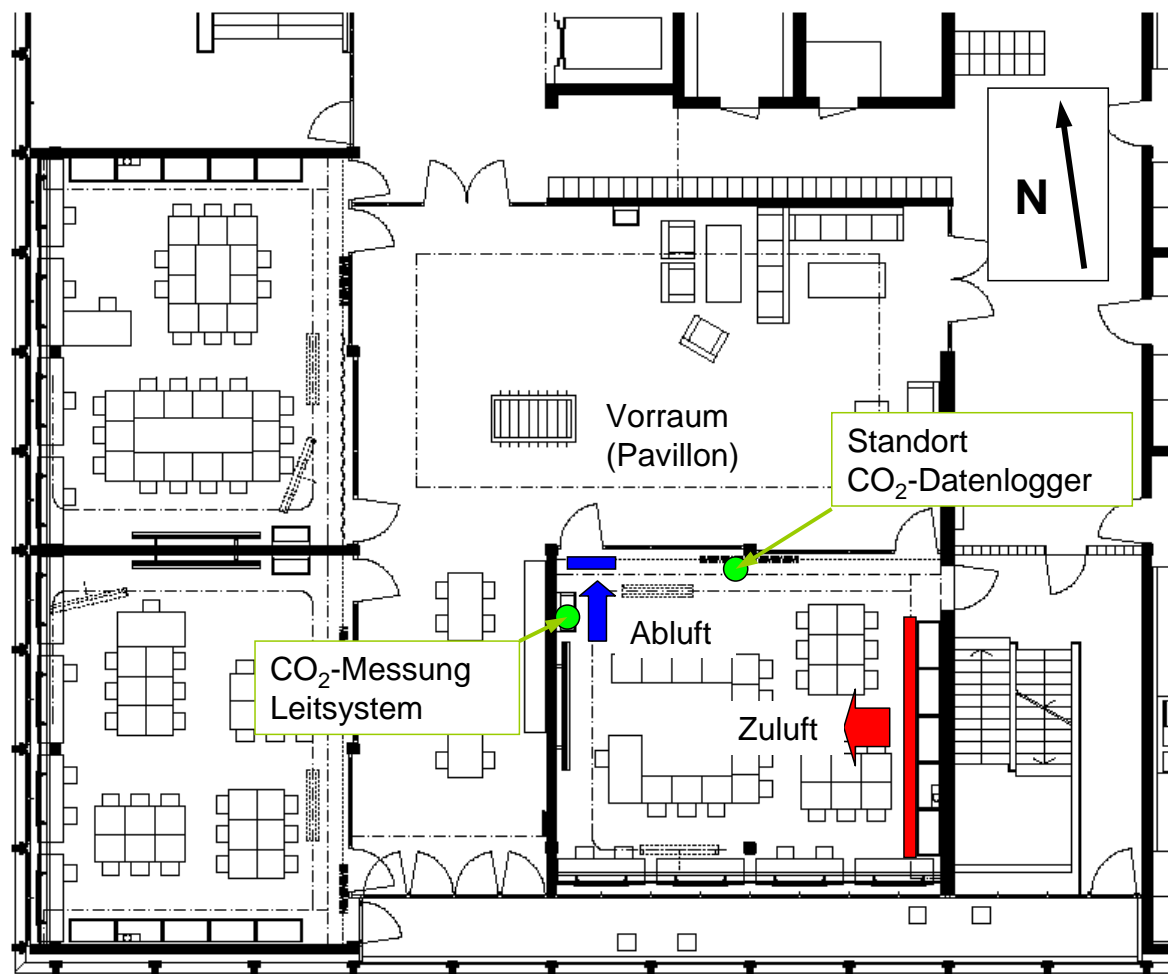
Grundriss Klassenverband, Schulhaus Birch Trakt A (Oberstufe)
